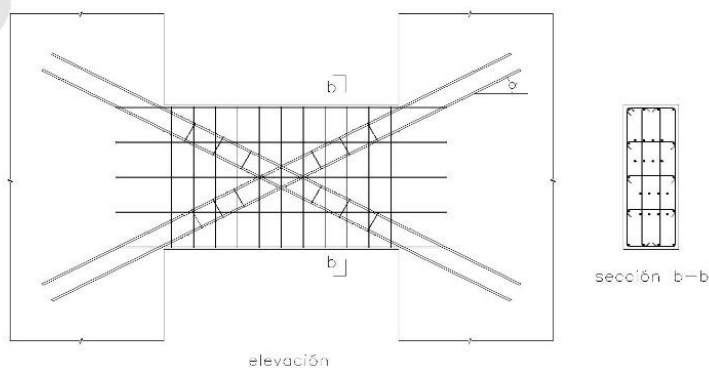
ii Refuerzo alternativo de vigas de acople
